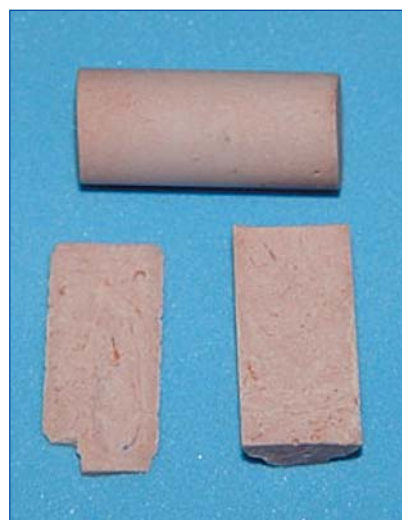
Probeta fracturada luego de ser sometida al ensayo de tracción diametral.
